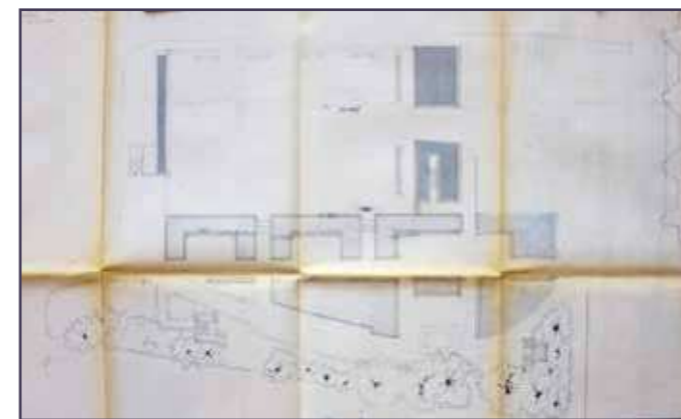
Aménagement du parvis de Notre-Dame et de ses abords, construction d'une crypte, plan de situation, 20-7-1972. Apparition du calepinage de la zone au pied de la façade de la cathédrale qui reproduit le tracé du plan de l'église Saint-Etienne (Archives de Paris, 1728W 16).
